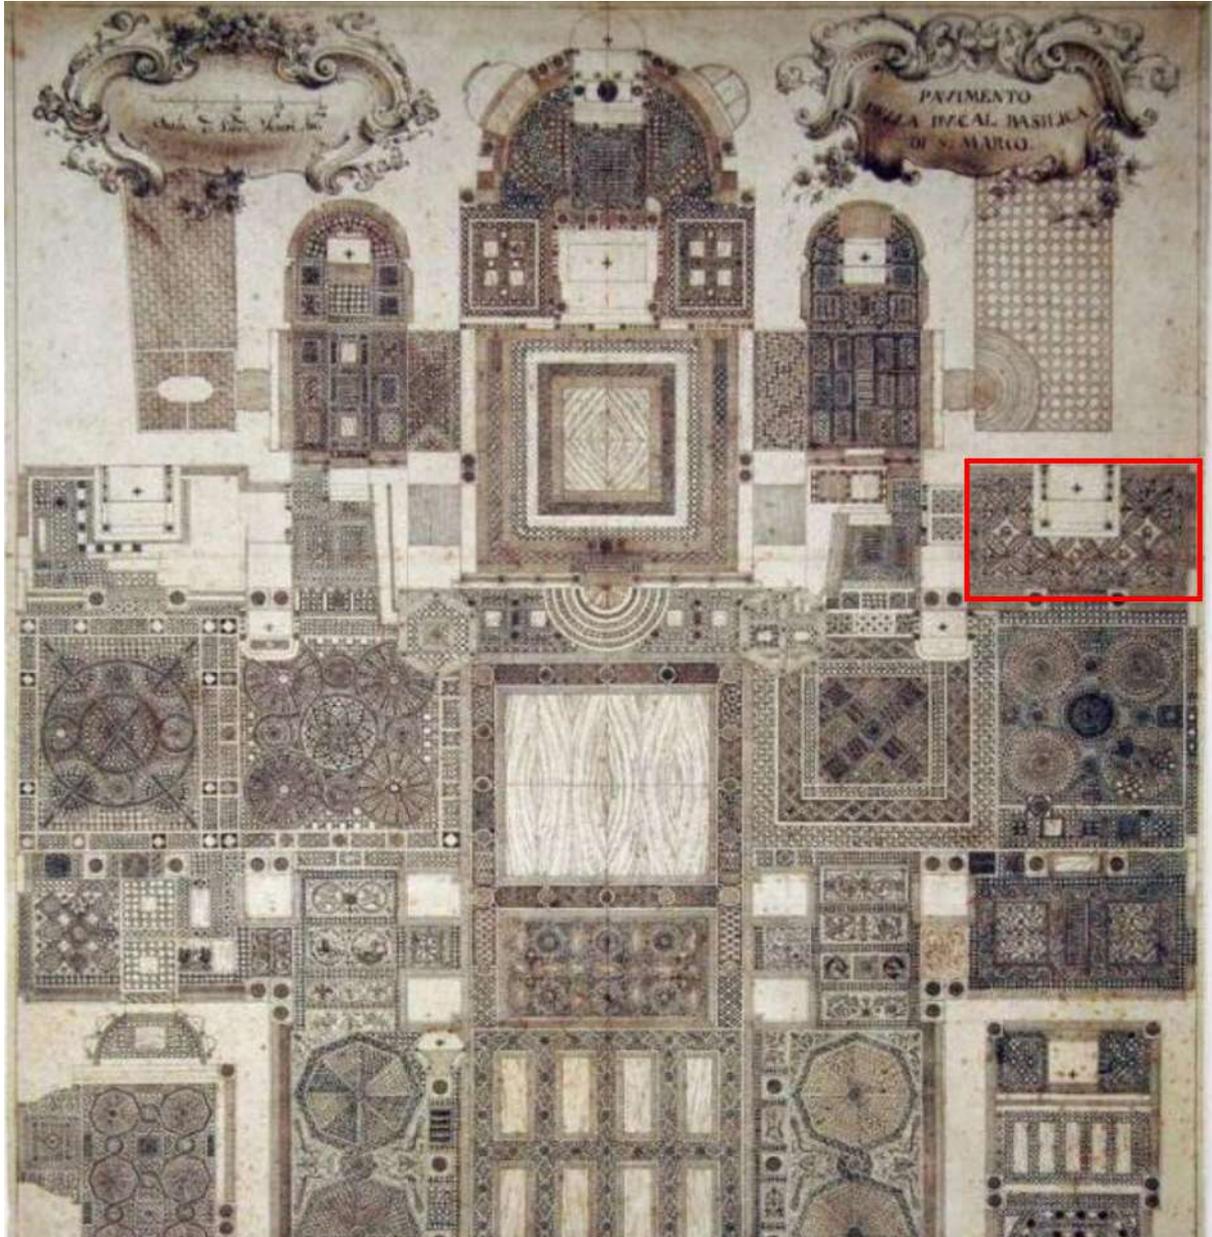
Antonio Visentini, rilievo della pavimentazione della basilica (XVIII secolo), dettaglio. In rosso è indicato il tratto di pavimentazione tessulare dell'altare del Santissimo bisognosa di restauro.
